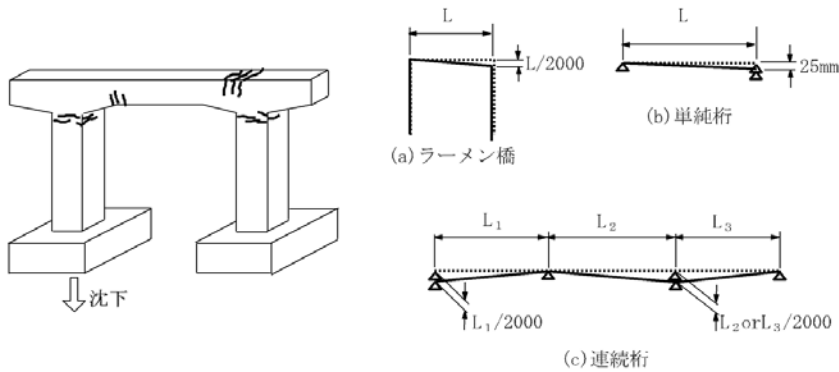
基礎の沈下によるひび割れ例と判定区分の目安
